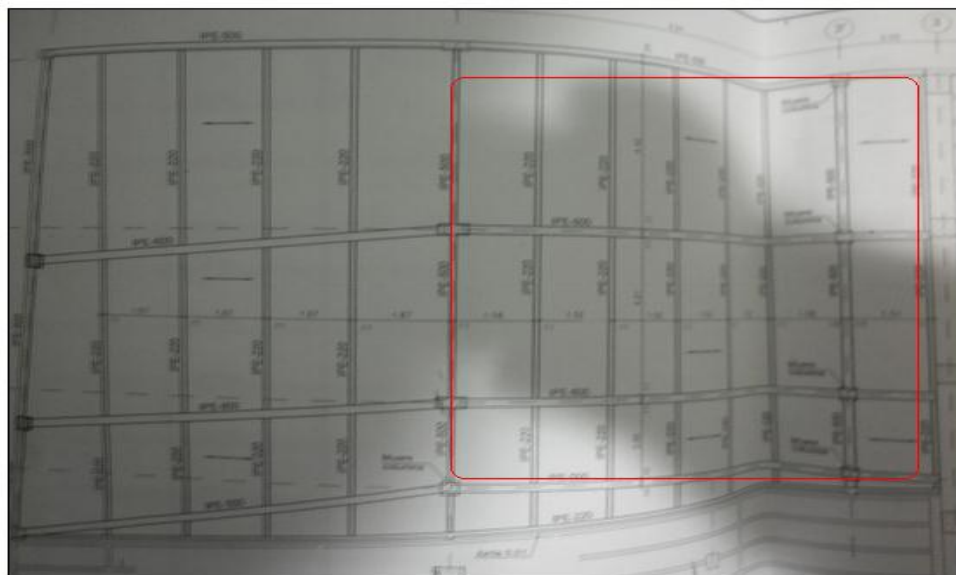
Fotografía de planos Gimnasio Cabrera
